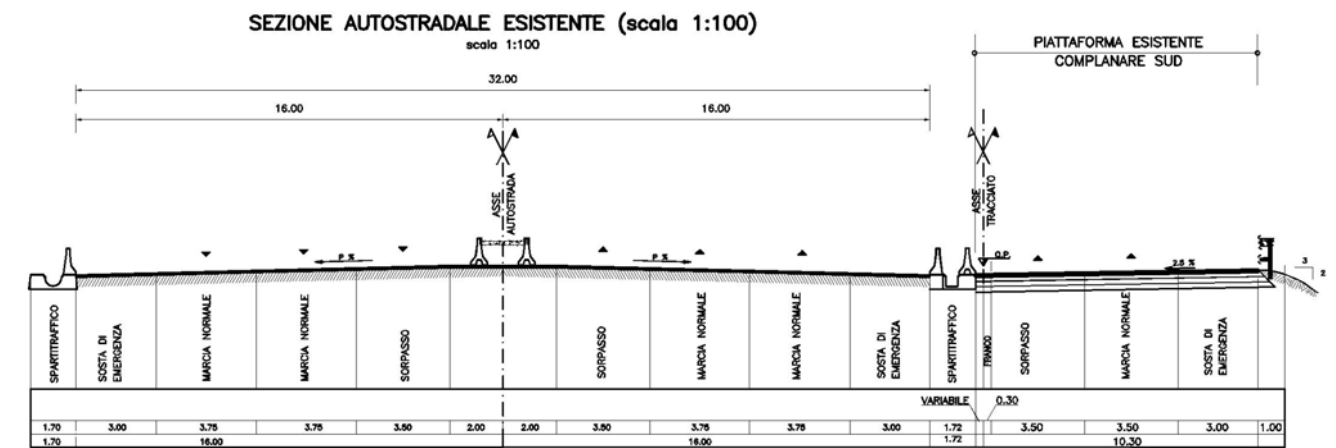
Sezione tipo esistente affiancamento con complanare sud
